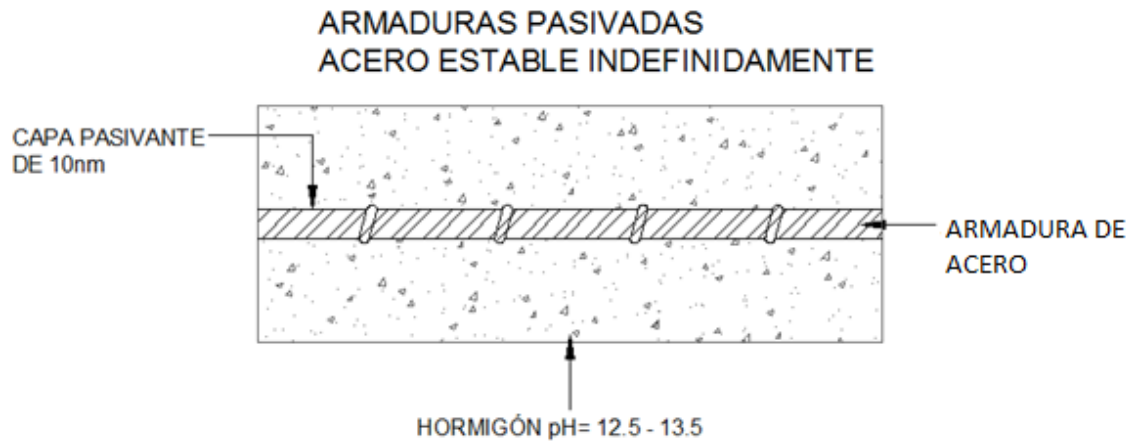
Estado natural de la armadura en el hormigón. Fuente: P. Garcés-Terradillos, M. A. Climent-Llorca, E. Zornoza-Gómez: Corrosión de armaduras en estructuras de hormigón armado.
